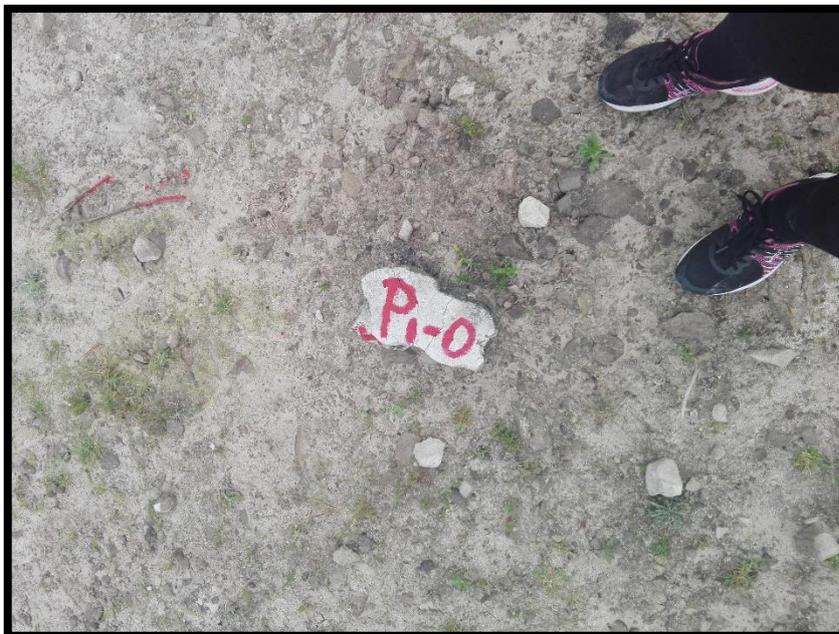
Levantamiento topográfico de la zona del proyecto
